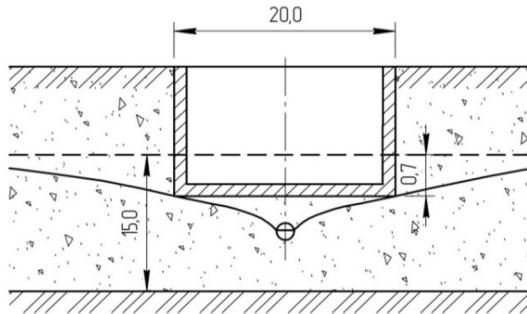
Схема к расчету защитного дренажа жилого дома
